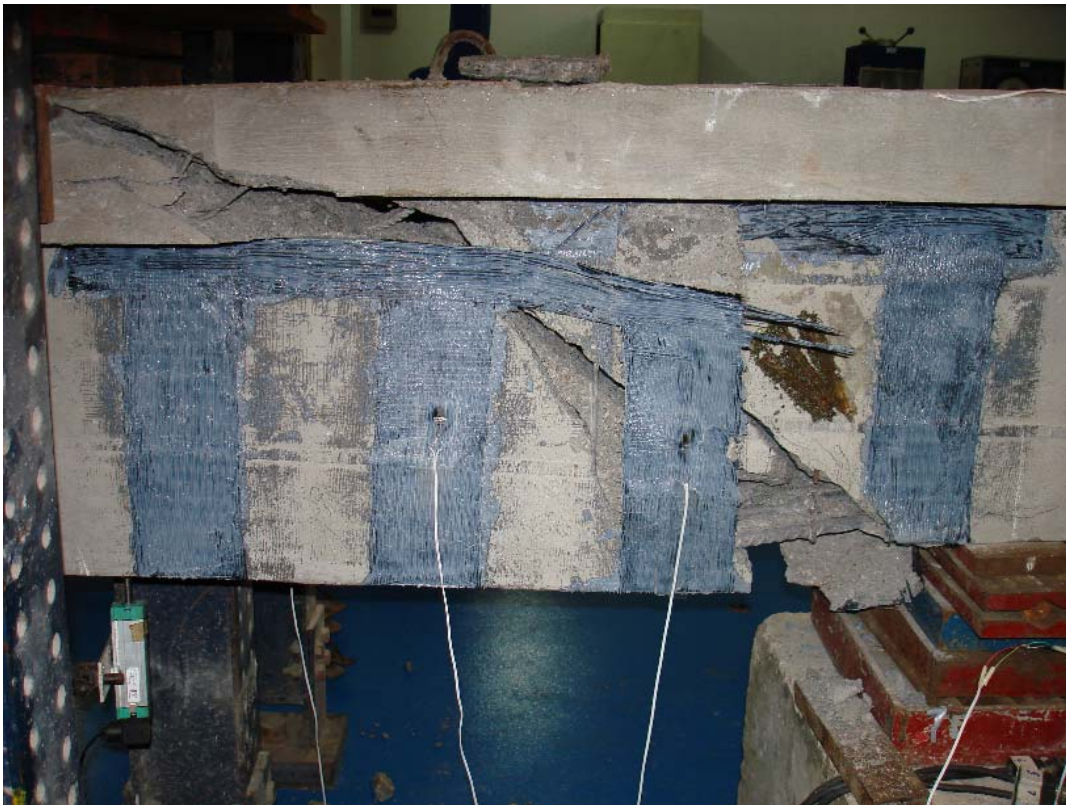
Detalhe da ruptura da viga VII-1 (2).
